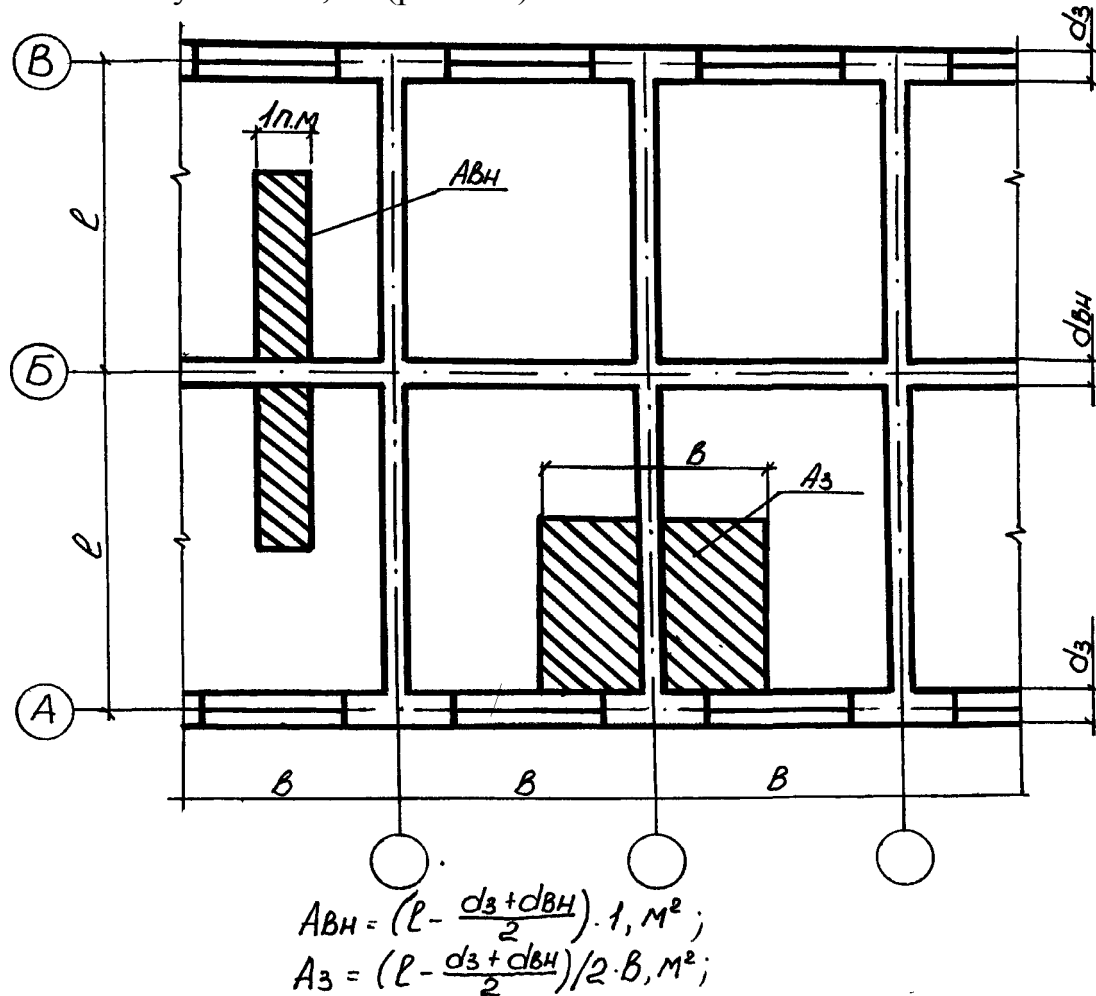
Схематичний план будівлі та вантажні площі для розрахункових фундаментів
